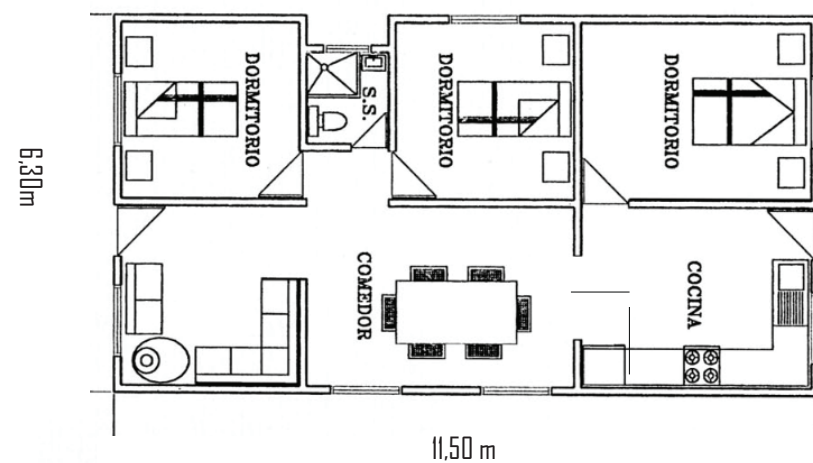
Planta arquitectónica “Casas Baratas” 1942
